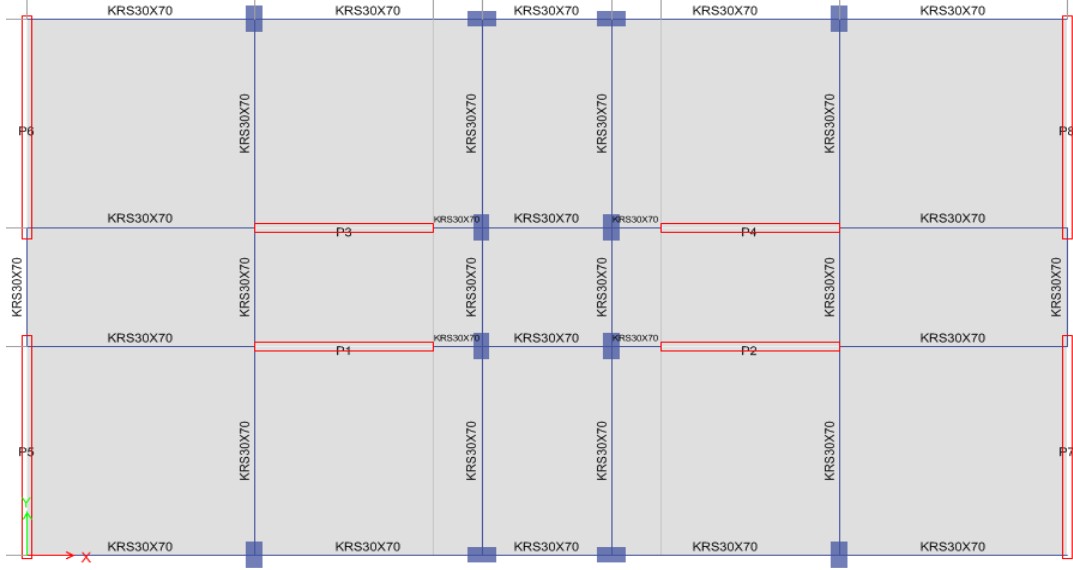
5 katlı ankastre mesnetli bina kat planı
